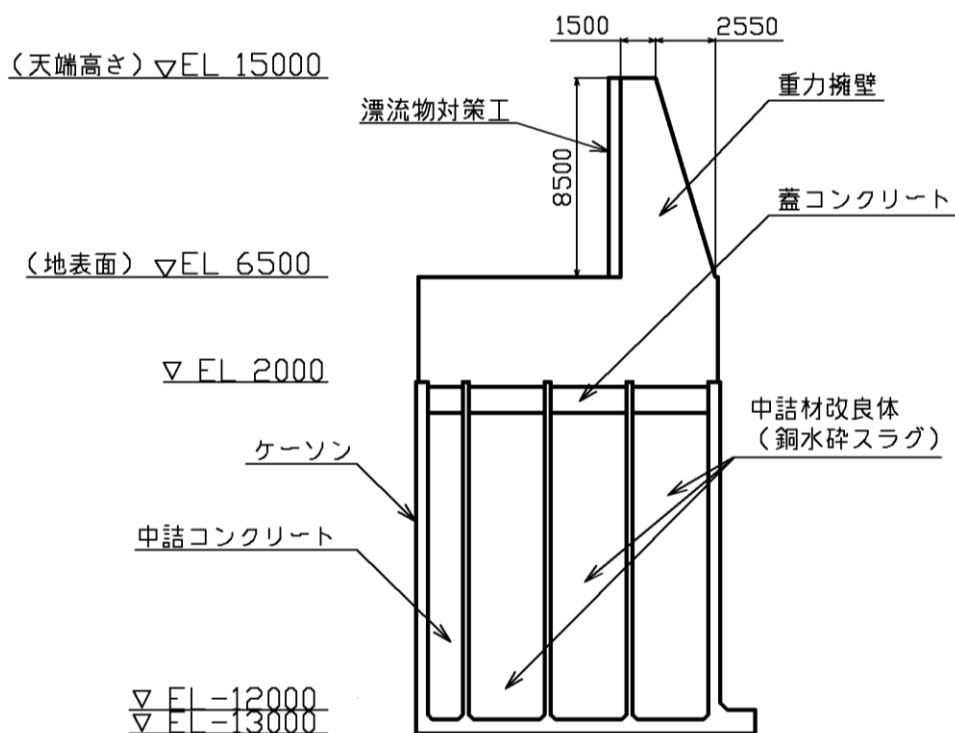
防波壁 (波返重力擁壁) の構造図 (②-②断面) (断面図)
